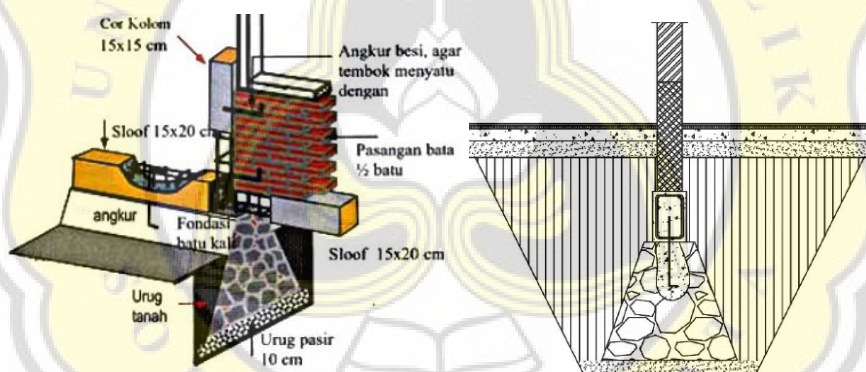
4. Pondasi Dangkal Batu Kali dan Foot Plate
